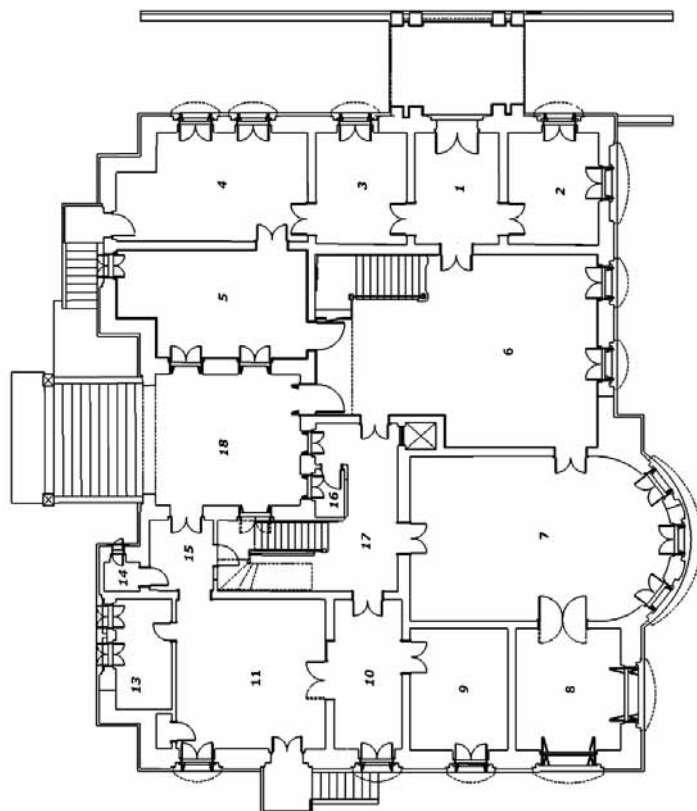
Planta baixa porão do palacete Garmatter.³¹
